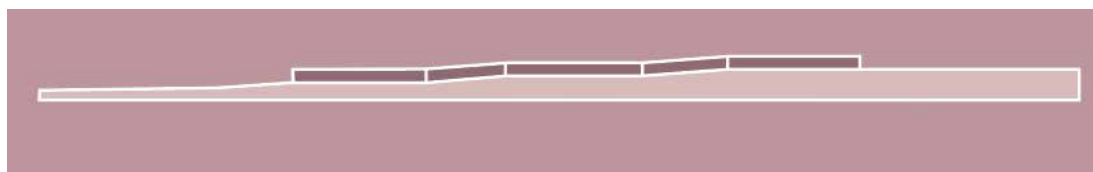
Sección longitudinal del terreno y su topografía modificada con la edificación implantada. Fuente: Moore y otros (2021)
